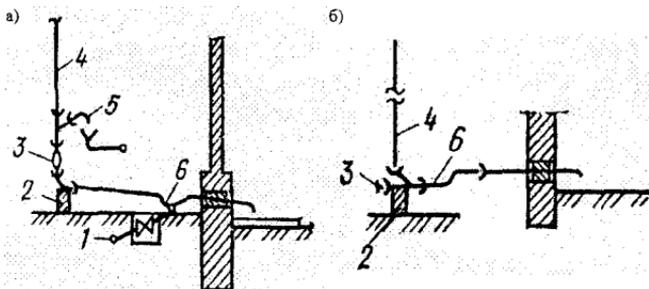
Устройство открытого выпуска для промышленных зданий:
